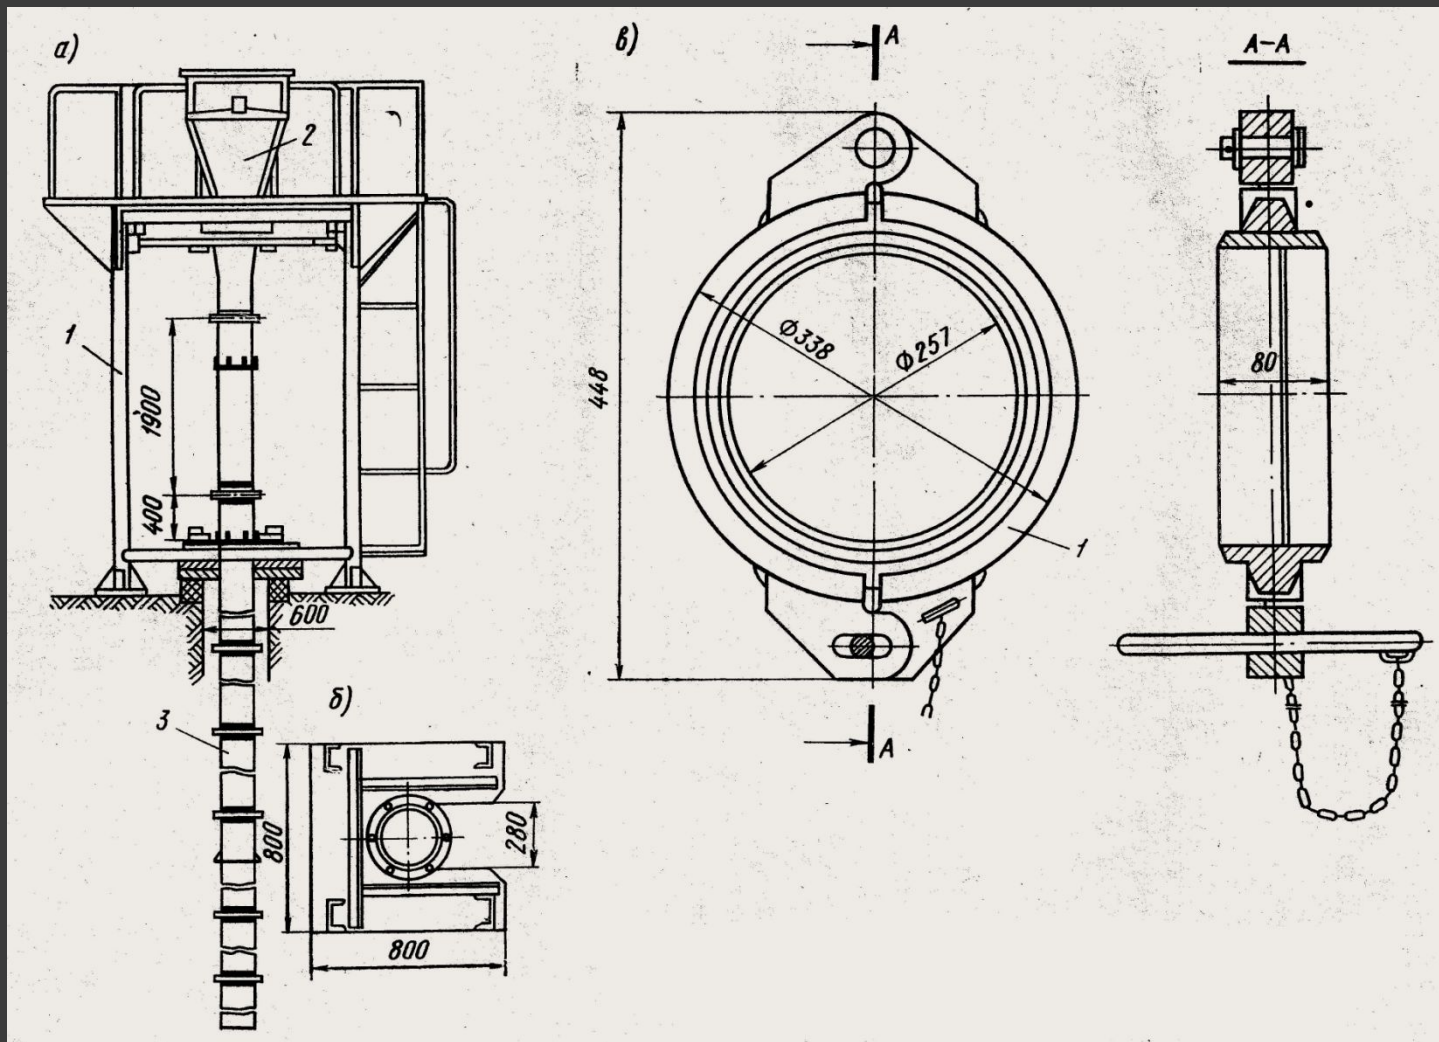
Оборудование для укладки бетона методом ВПТ
